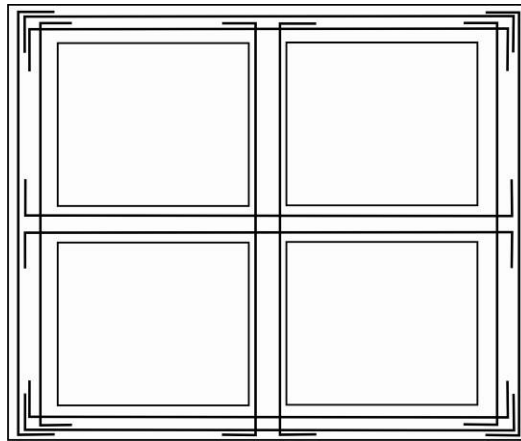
Ganchos de anclaje en vigas de cimentación transversales
